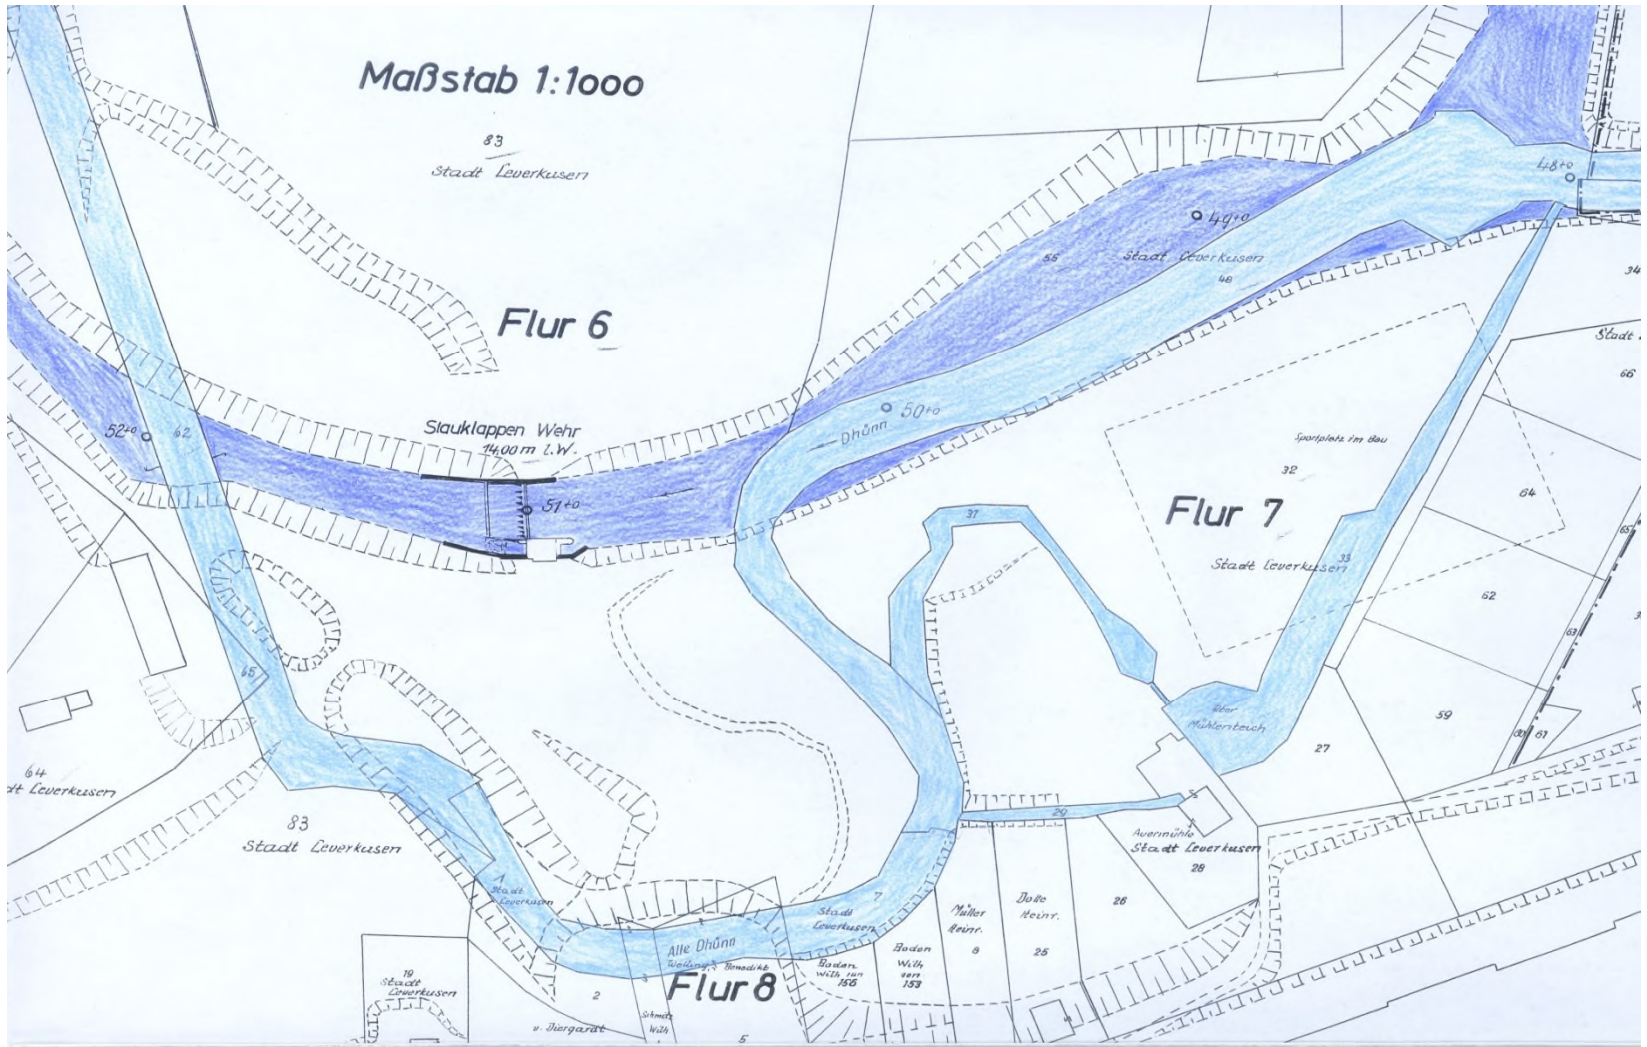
Lageplan mit dem alten Dhünnverlauf und der Auermühle. Das alte Wehr befand sich in etwa bei der Station 48+0.
